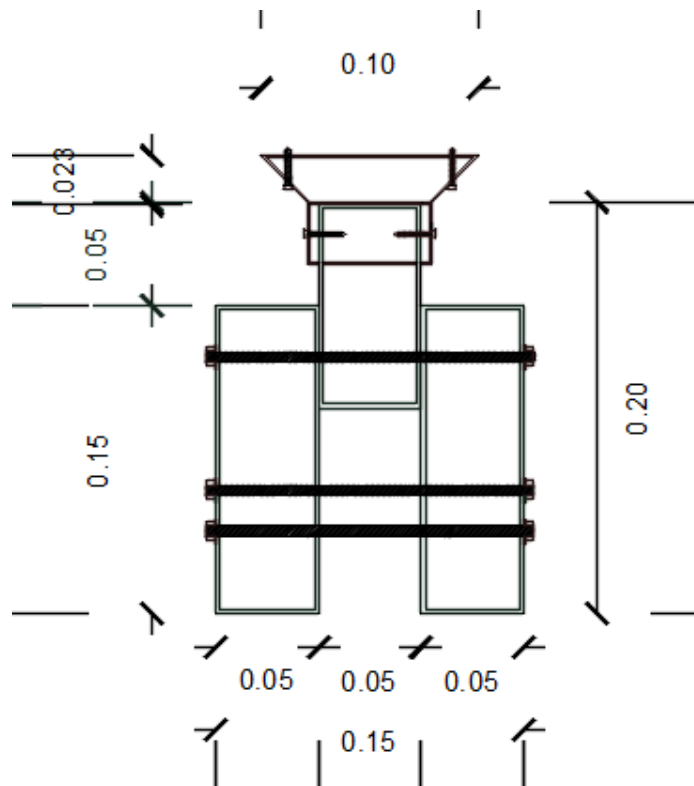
Elaboración propia, Alzado detalle de anclaje en bambú.
